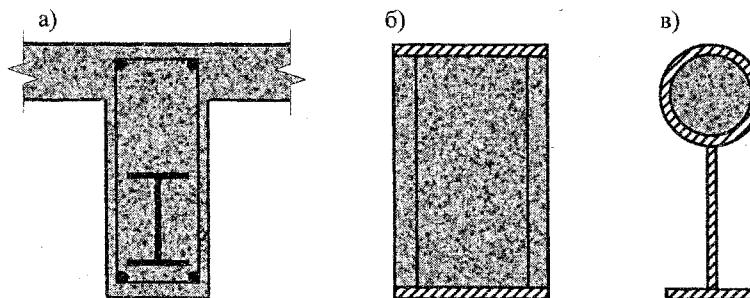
Поперечні перерізи сталезалізобетонних балок і ригелів:
